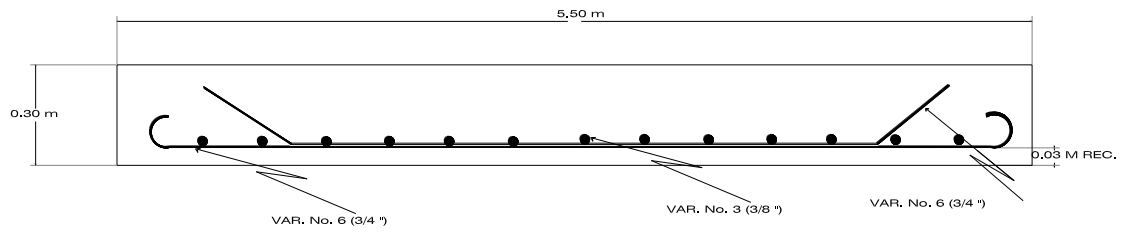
Armado de la losa (corte Lado Corto).
